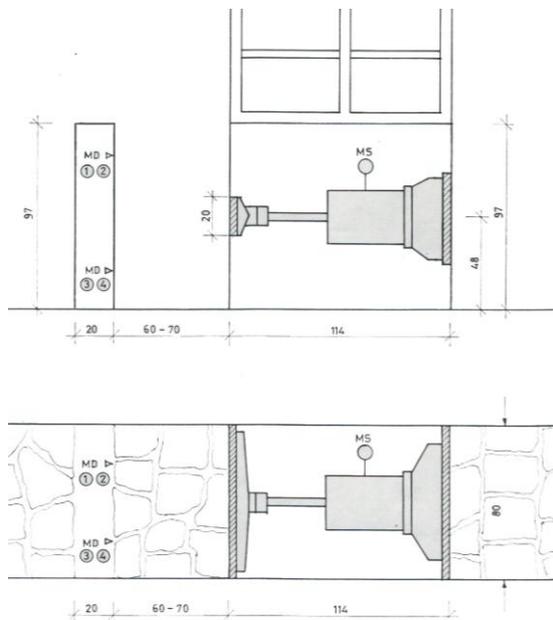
Detalle de la prueba experimental, muro norte del naos, 1986.
